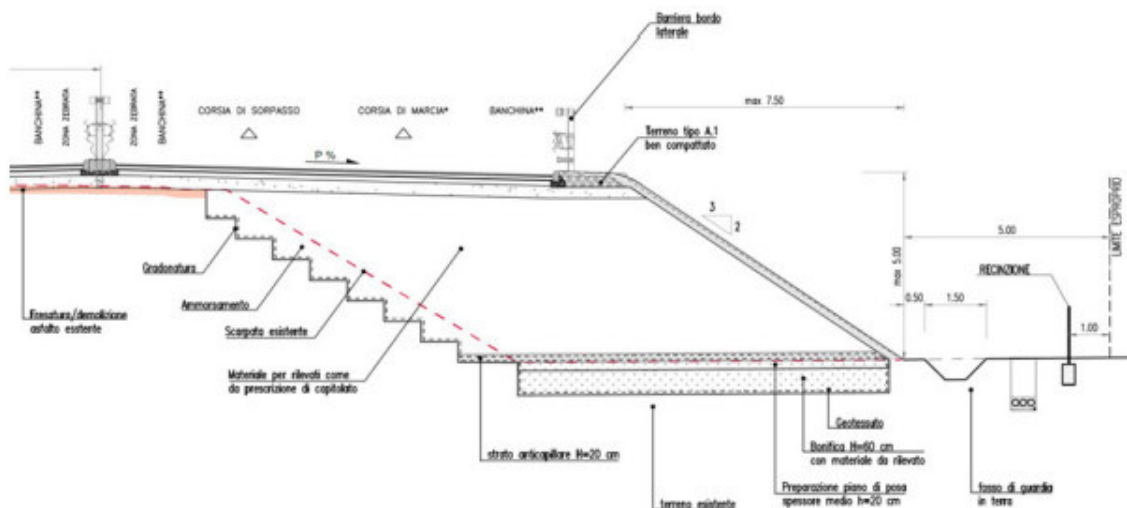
Sezione tipo in asse principale in rettilineo con allargamento da un lato
